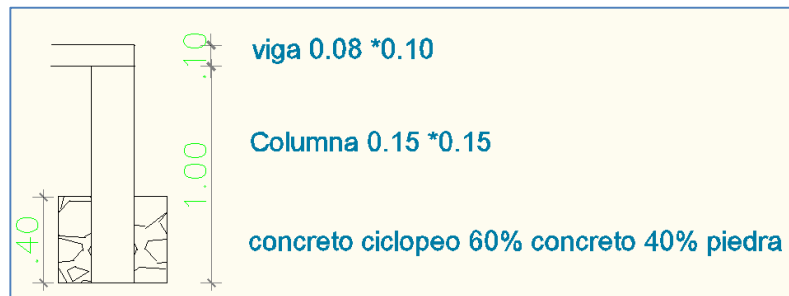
Cimentación pilares fundidos en concreto ciclópeo vivienda Prototipo
